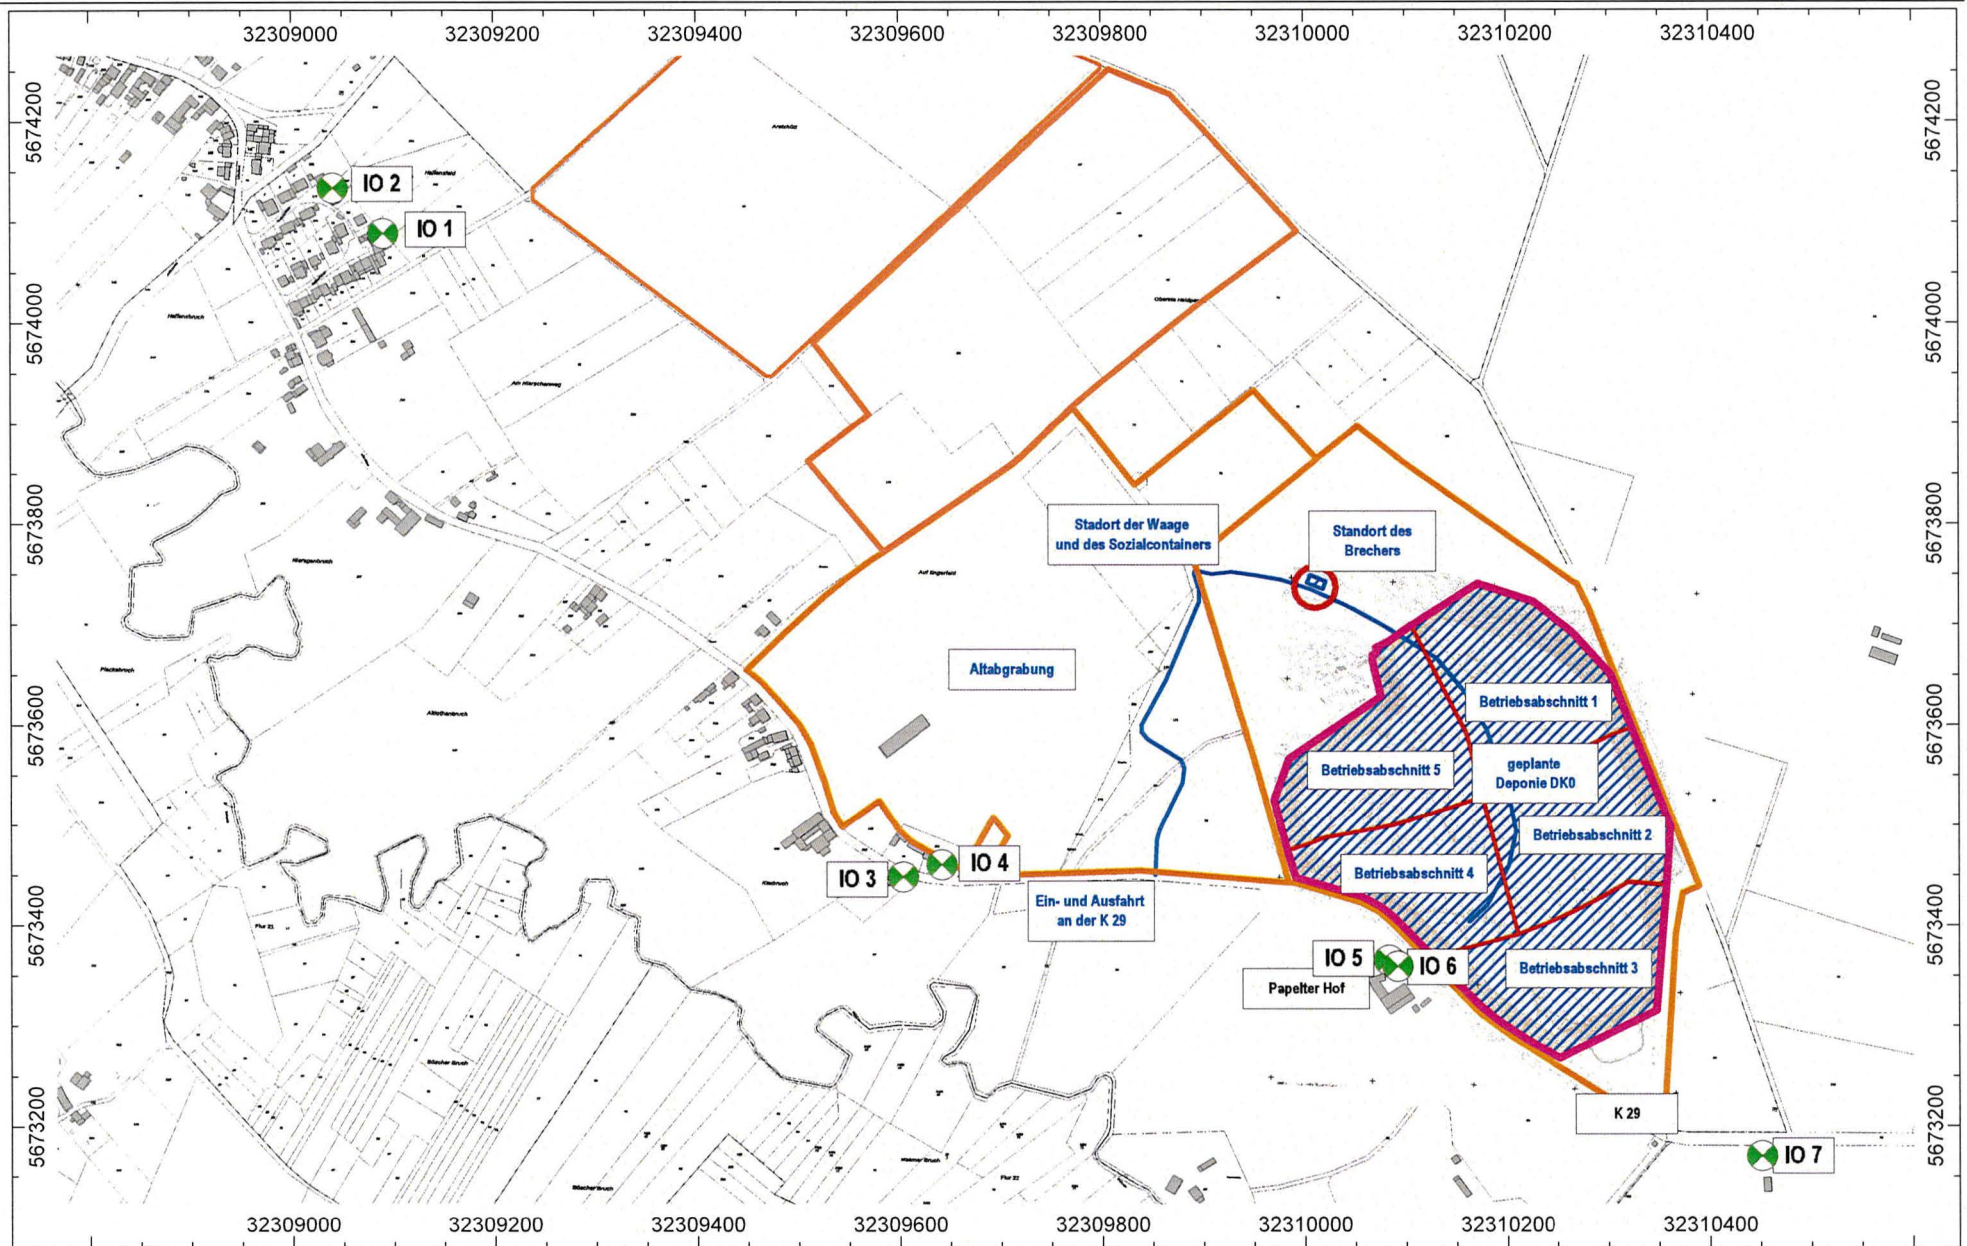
Lageplan (Maßstab 1:7.500)
